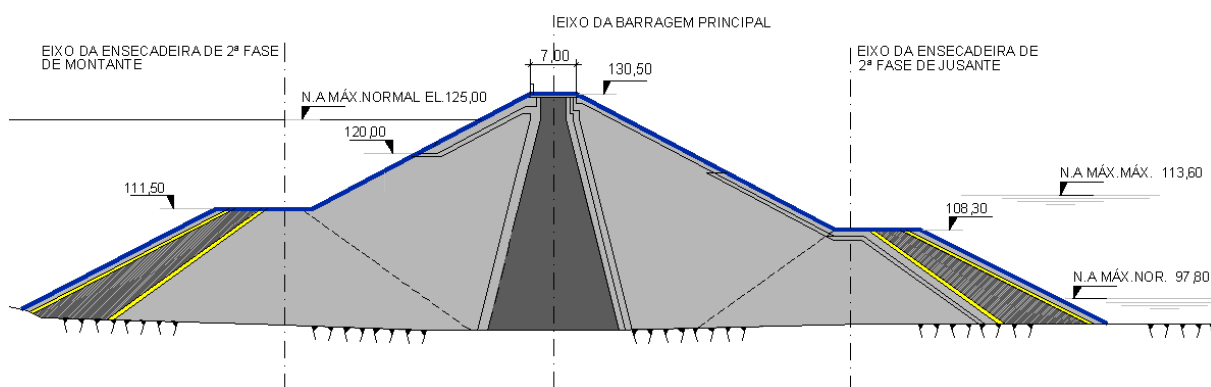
Seção da barragem do AHE Santa Isabel.
